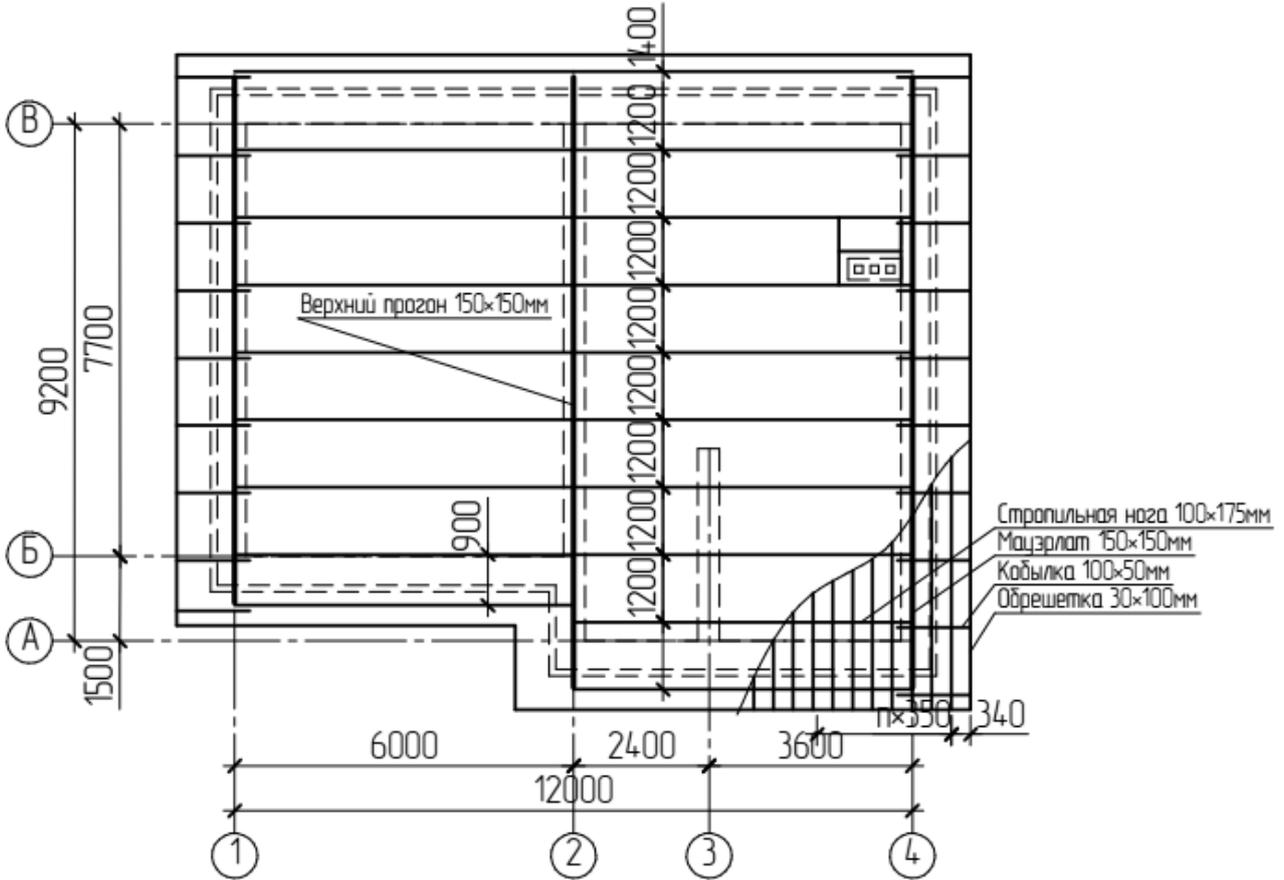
Пример выполнения схемы расположения элементов наслонных стропил
